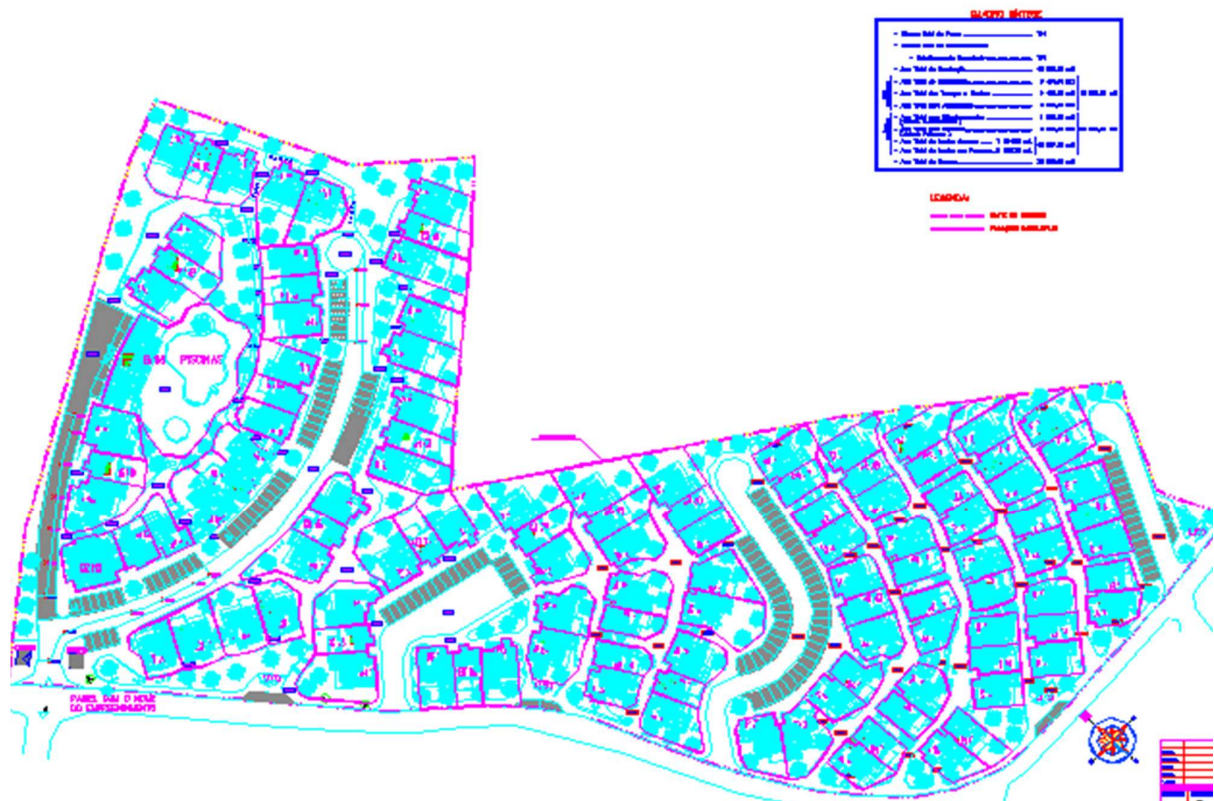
PLANTA SÍNTESE THE VIEW II
